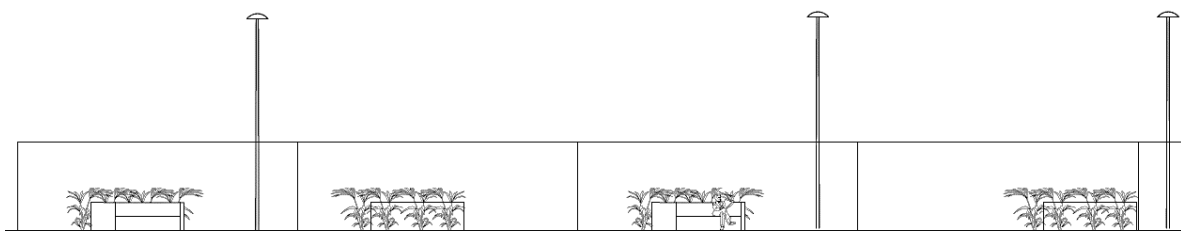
Vista general en alzado de la colocación de las bancas tipo "L".
